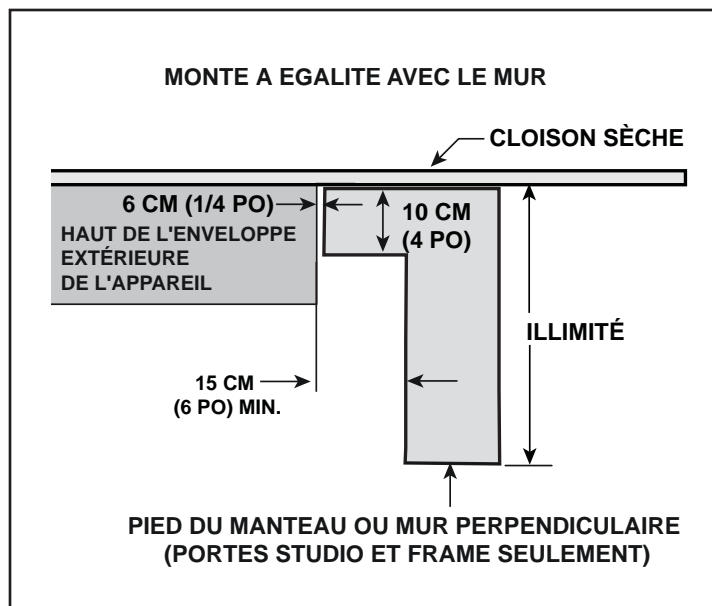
Pied du manteau du foyer ou saillie du mur non combustible (acceptable de part et d'autre de l'enveloppe extérieure)
